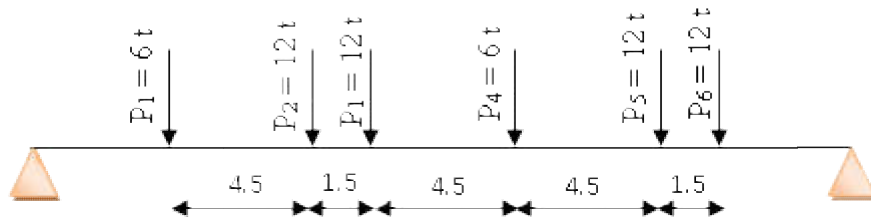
système Bc disposition de deux camions sur la chaussée (sens longitudinal)
